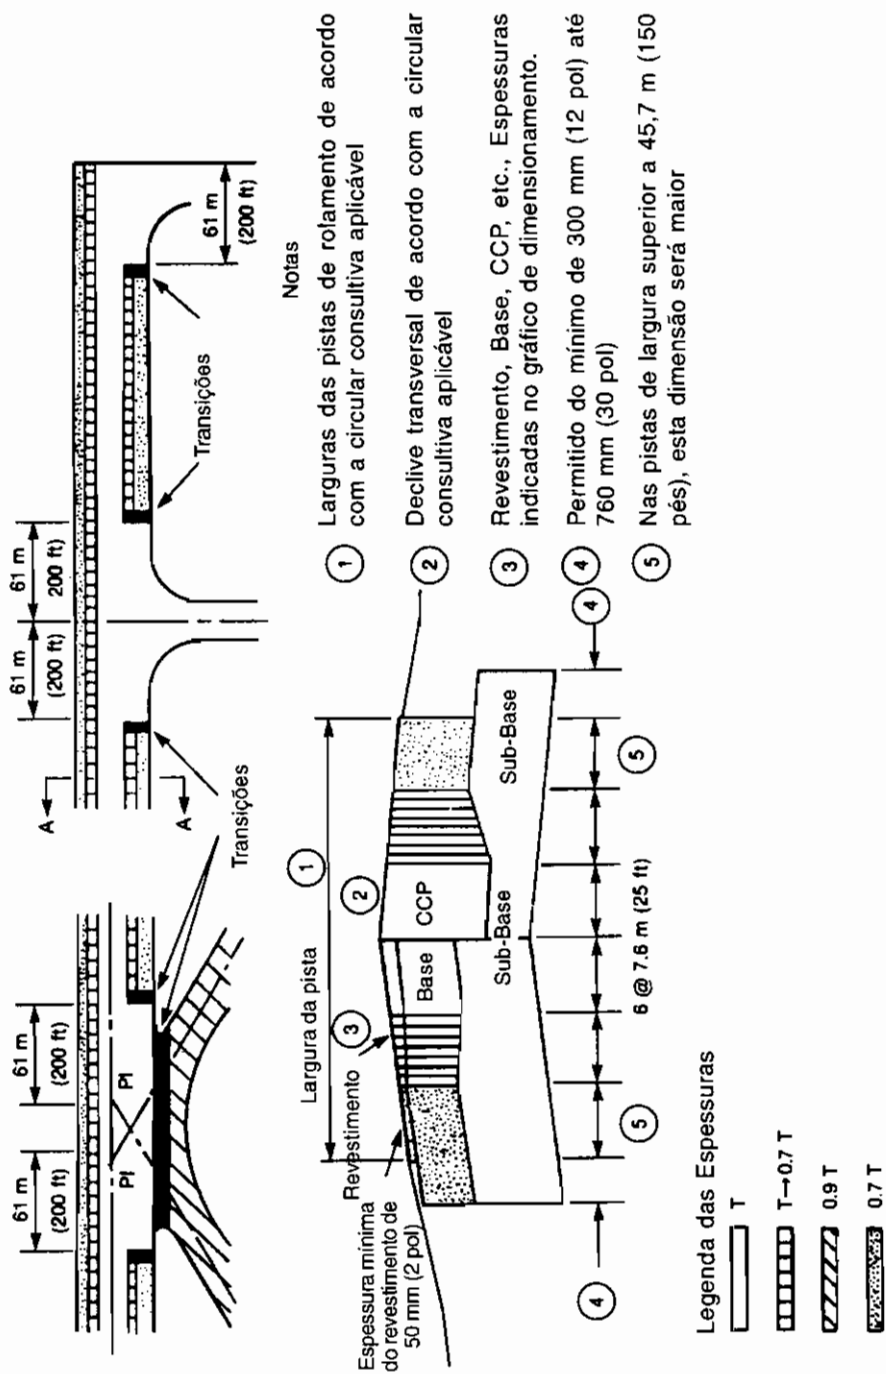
Planta e Seção Transversal Típicas de Pistas (de Pouso e Decolagem)
